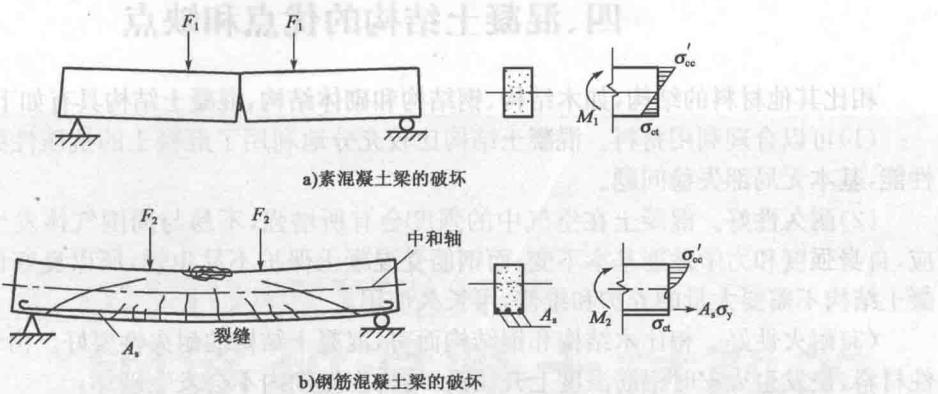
素混凝土梁和钢筋混凝土梁的破坏
